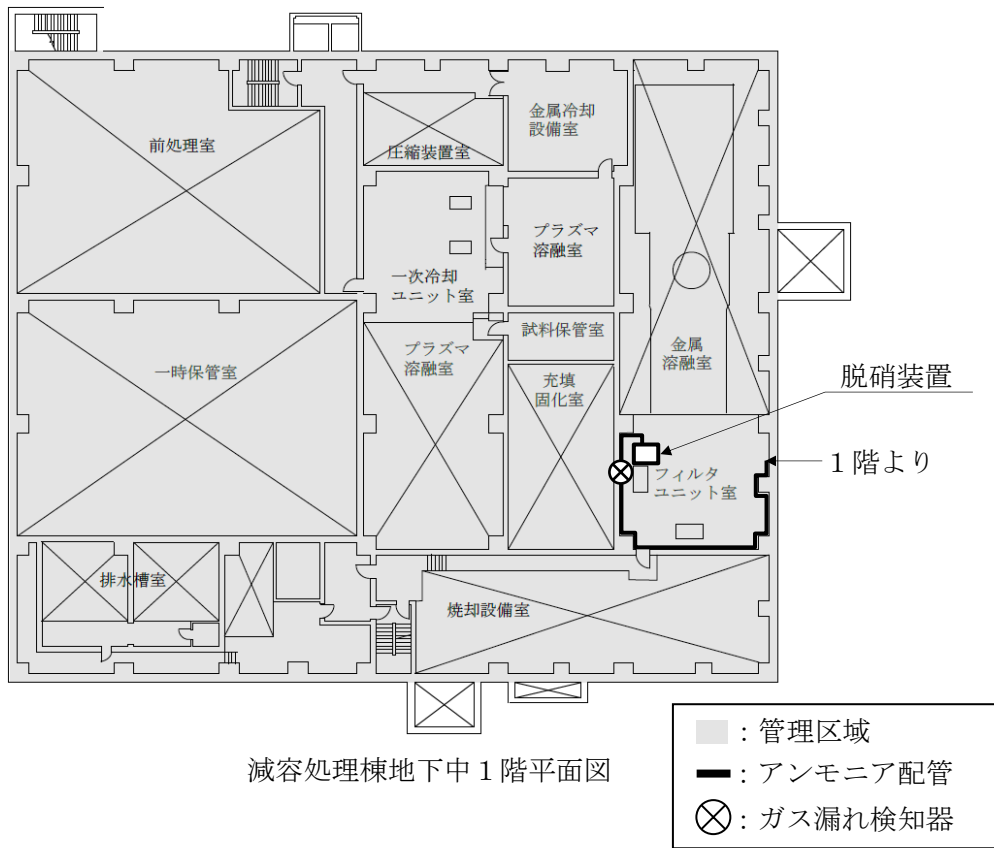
(1/3) 減容処理棟アンモニアガス供給設備配置図
